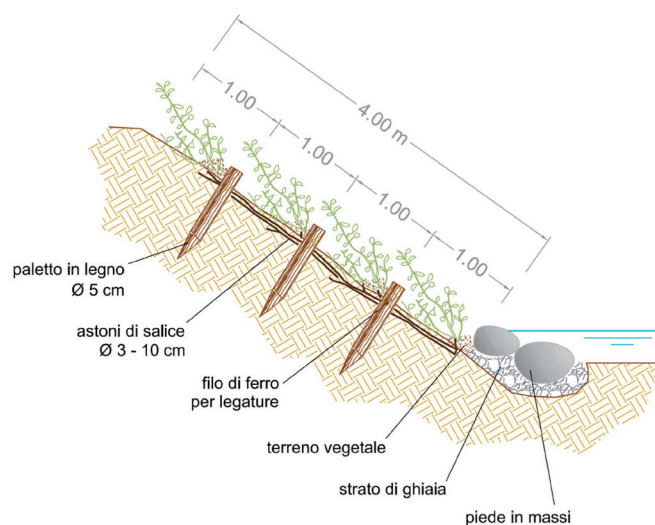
SEZIONE DI UN INTERVENTO TIPO.
